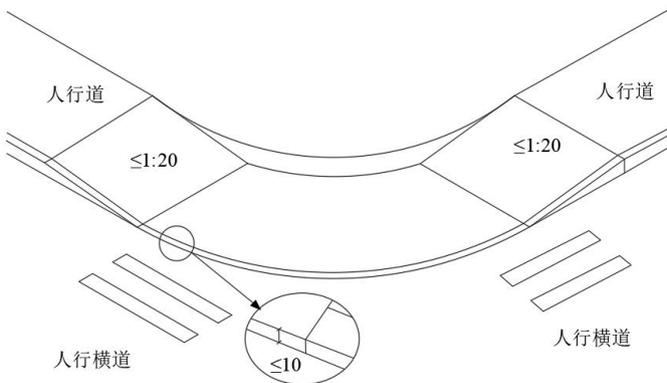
交叉口单面坡缘石坡道示意图 (mm)
